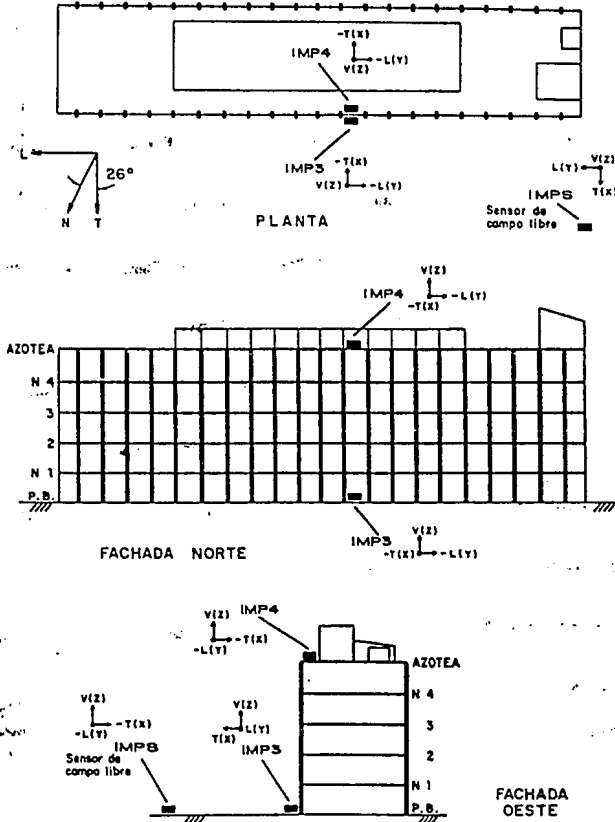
niveles, con estructura de concreto, en zona de lago (ref 1).
